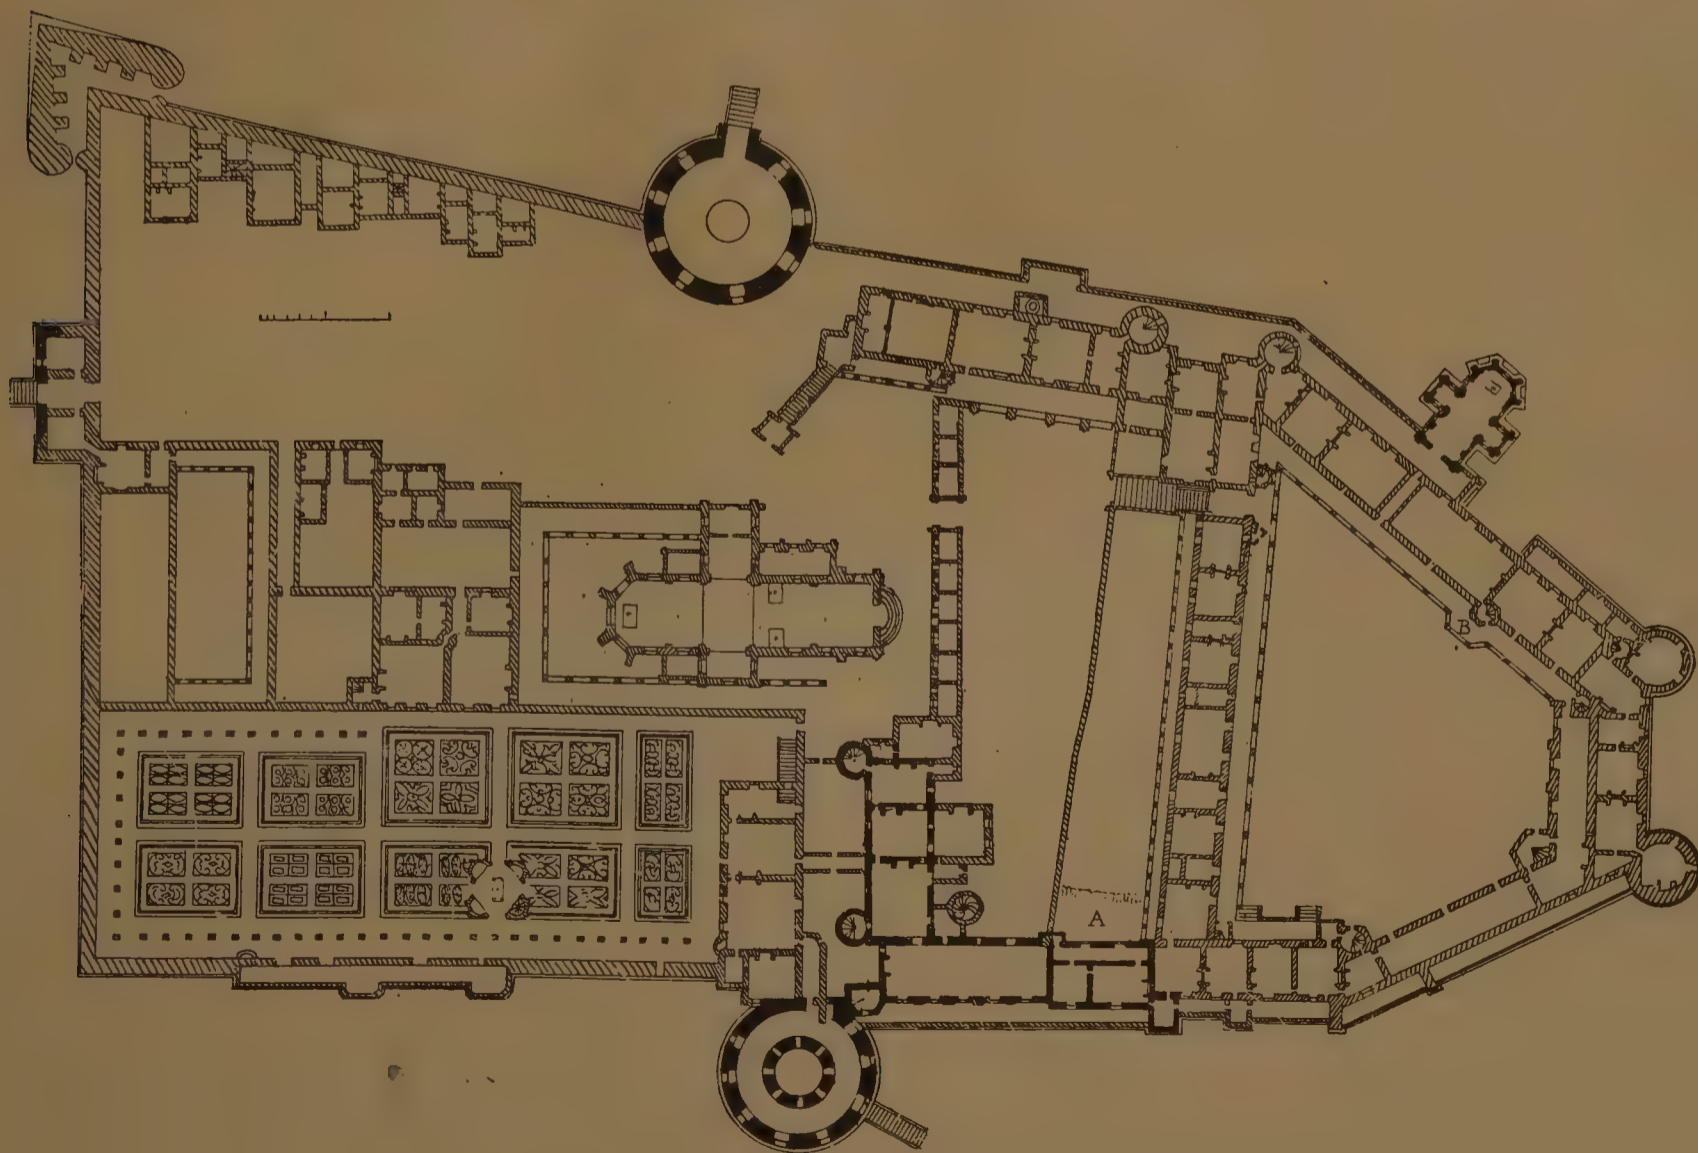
PLAN GÉNÉRAL : A COUR BASSE VISIBLE ACTUELLEMENT. — B FONDATION RETROUVÉE.
